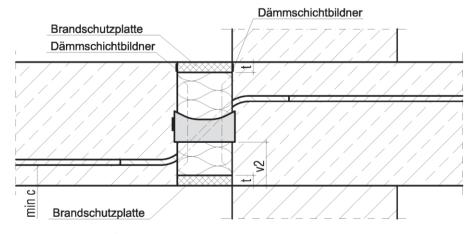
Schöck Isokorb<sup>®</sup> Typ Q (Ausführungsvariante A) gem. Abschnitt 3.1.2
